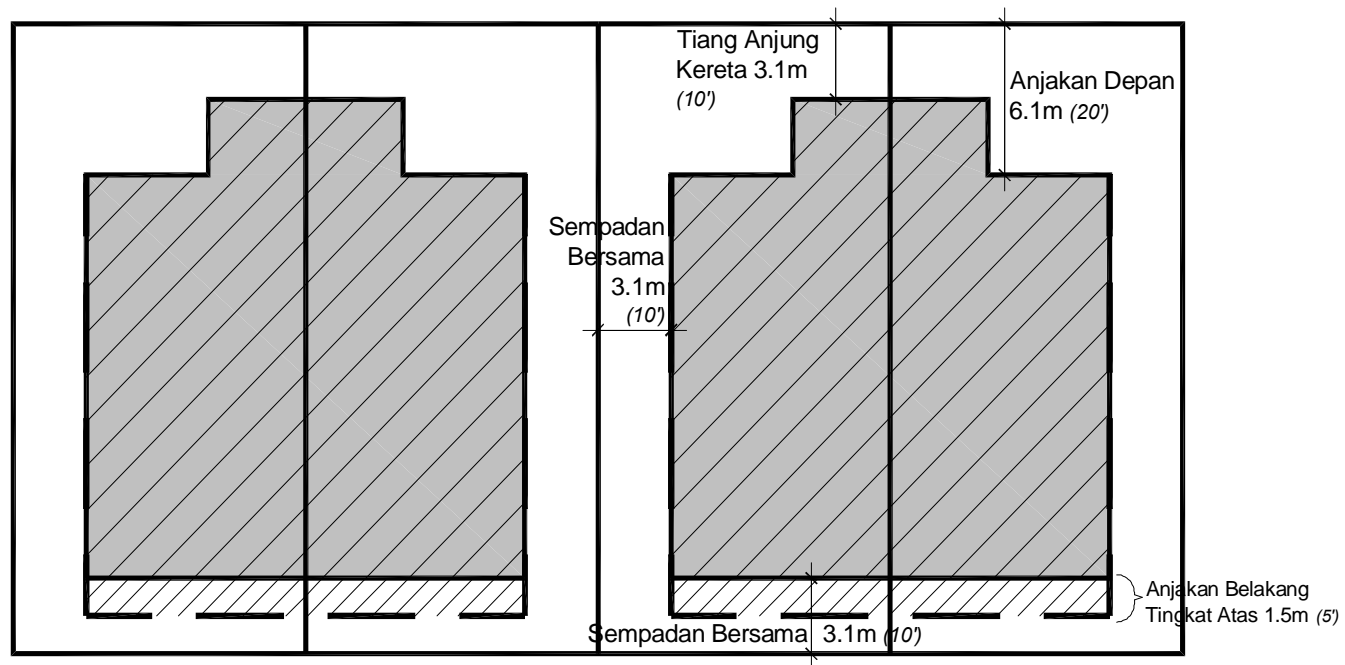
Contoh Ukuran Saiz Lot Dan Anjakan Bangunan Bagi Rumah Teres.
